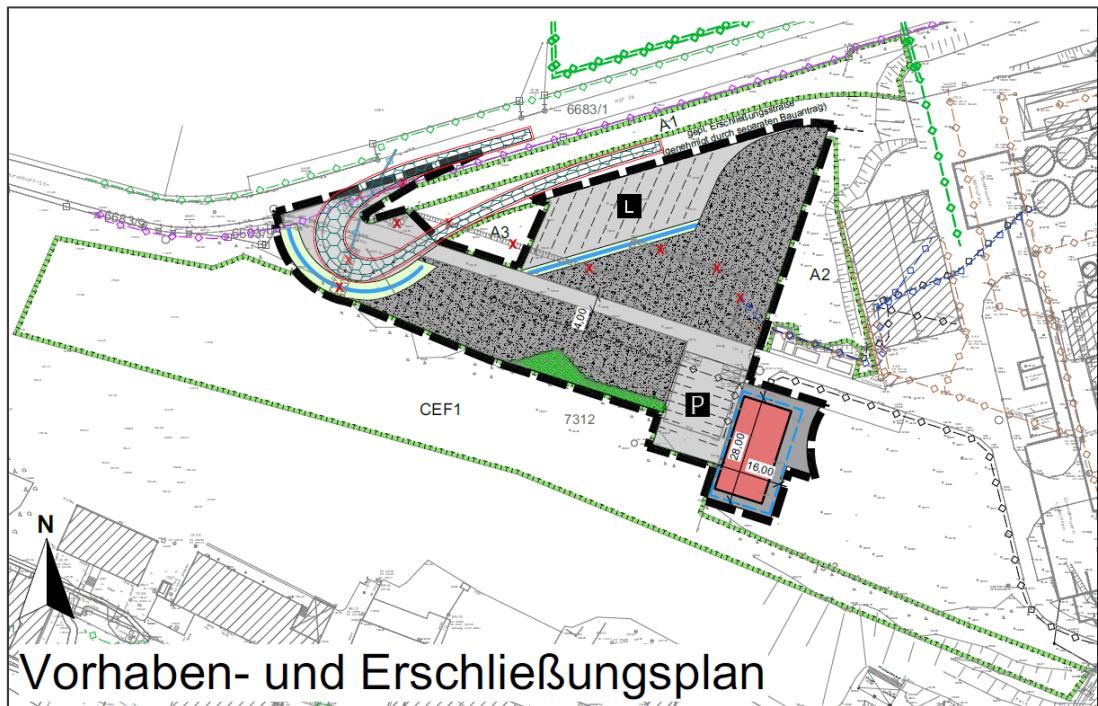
Vorhaben- und Erschließungsplan des Bebauungsplans (schwarz gestrichelt = Geltungsbereich) mit versiegelten Flächen für die Zufahrt sowie die LKW- und PKW-Stellplätze (hellgrau), dem Mehrzweckgebäude (rosa), den geschotterten Lagerflächen, Baustelleneinrichtungs-/Vormontageflächen und weiteren PKW-Stellplätzen (temporär für Besucher Saalbau) (dunkelgrau), Sickermulden (hellgrün mit blauer Linie) sowie dem Erhaltungsgebot Gehölze (dunkelgrün). Ausgleichsmaßnahmen aus dem Cap2U-Bauantrag angrenzend zum Geltungsbereich (A1, A2, A3, CEF1) (Stand 20.09.2024)
